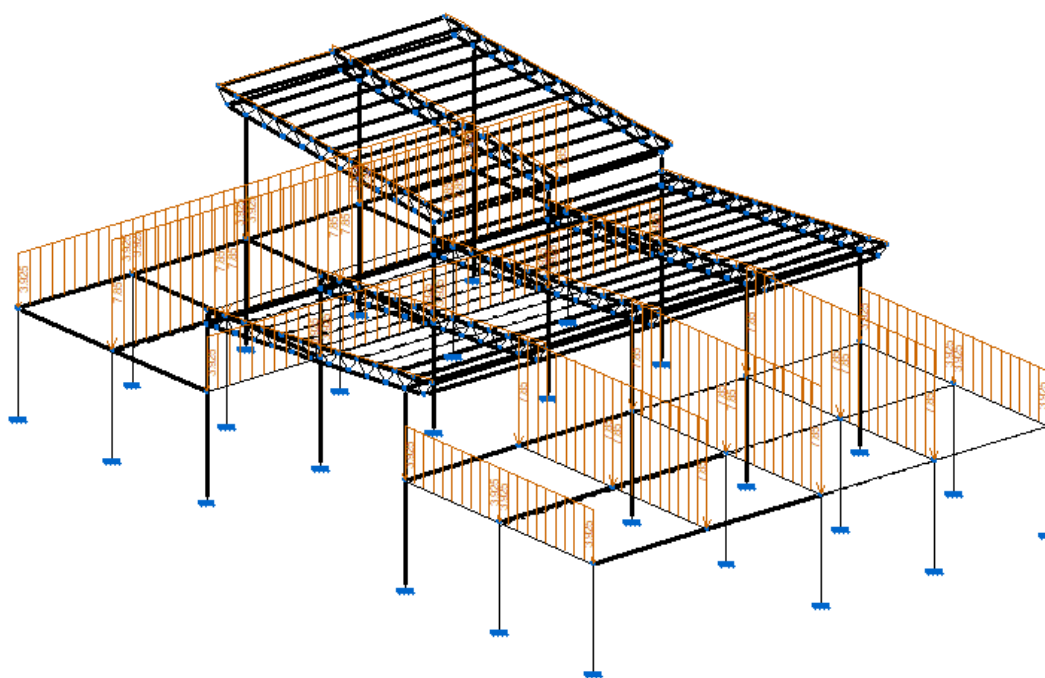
Cargas Permanentes en estructura metálica. Fuente: Elaboración propia
